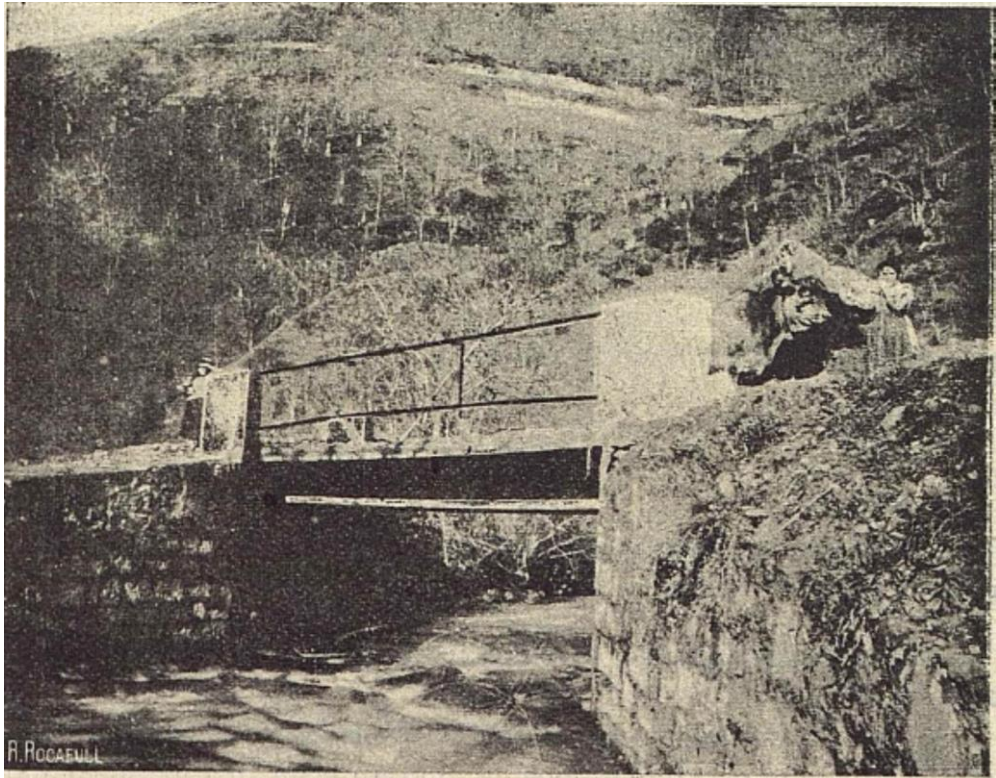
Puente de la carretera de Santa Rosa. Mieres, Asturias. Puentes de fábrica y hormigón armado Tomo I. 1925. Biblioteca digital Fundación Juanelo Turriano
